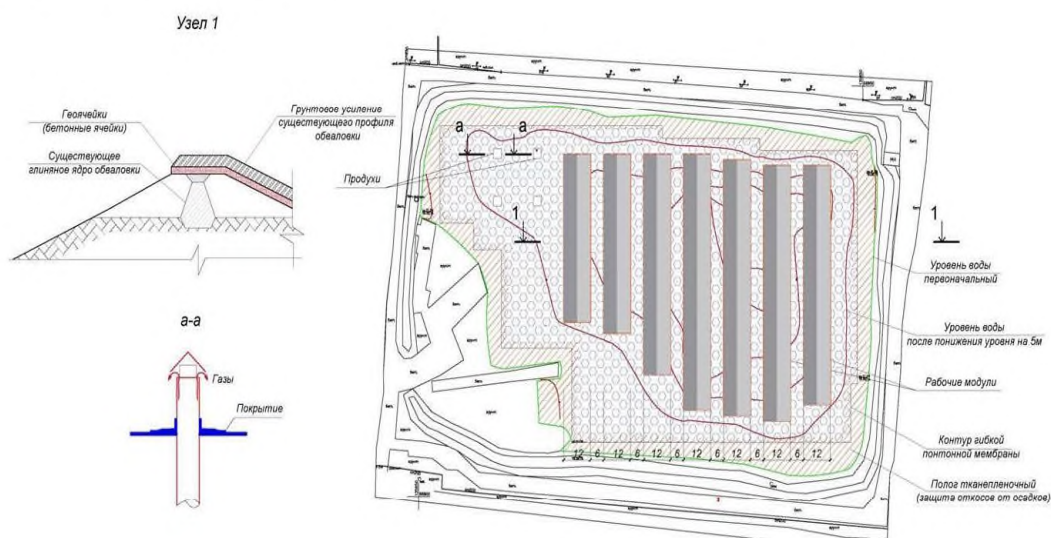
Укрытие модульными каркасными конструкциями с опиранием на понтоны
